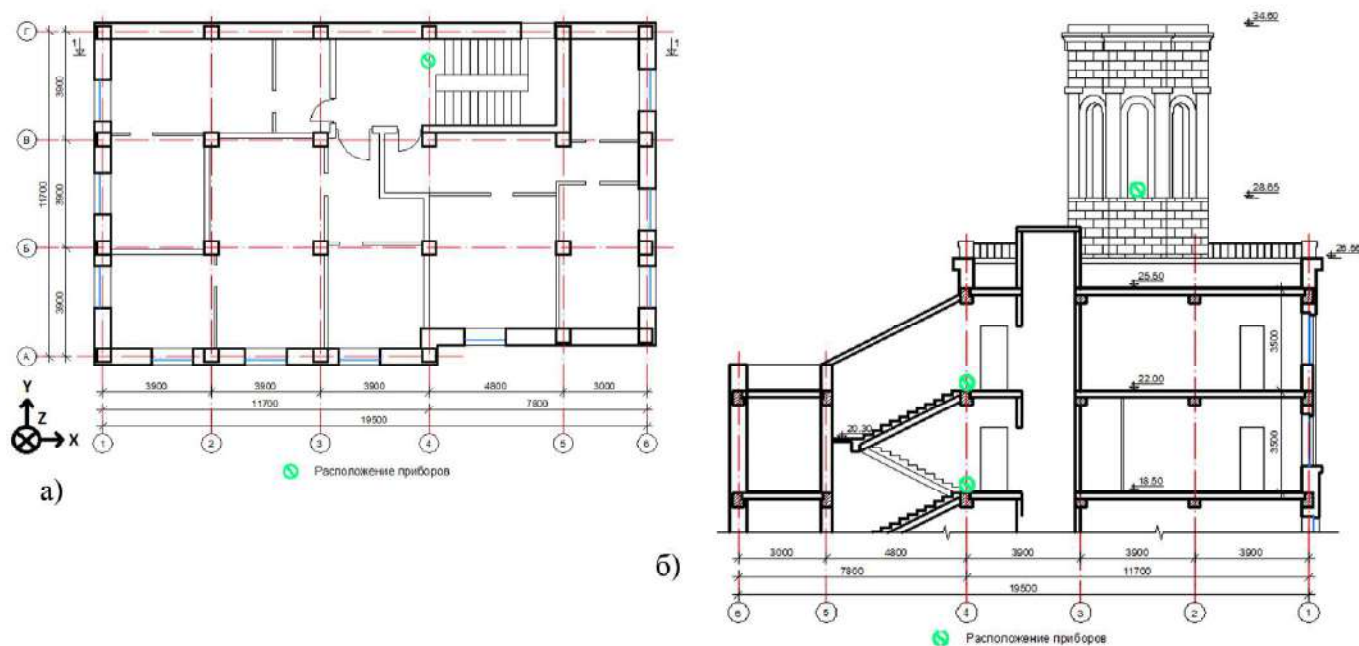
Схематический план здания и 1-1 разрез верхней части здания
